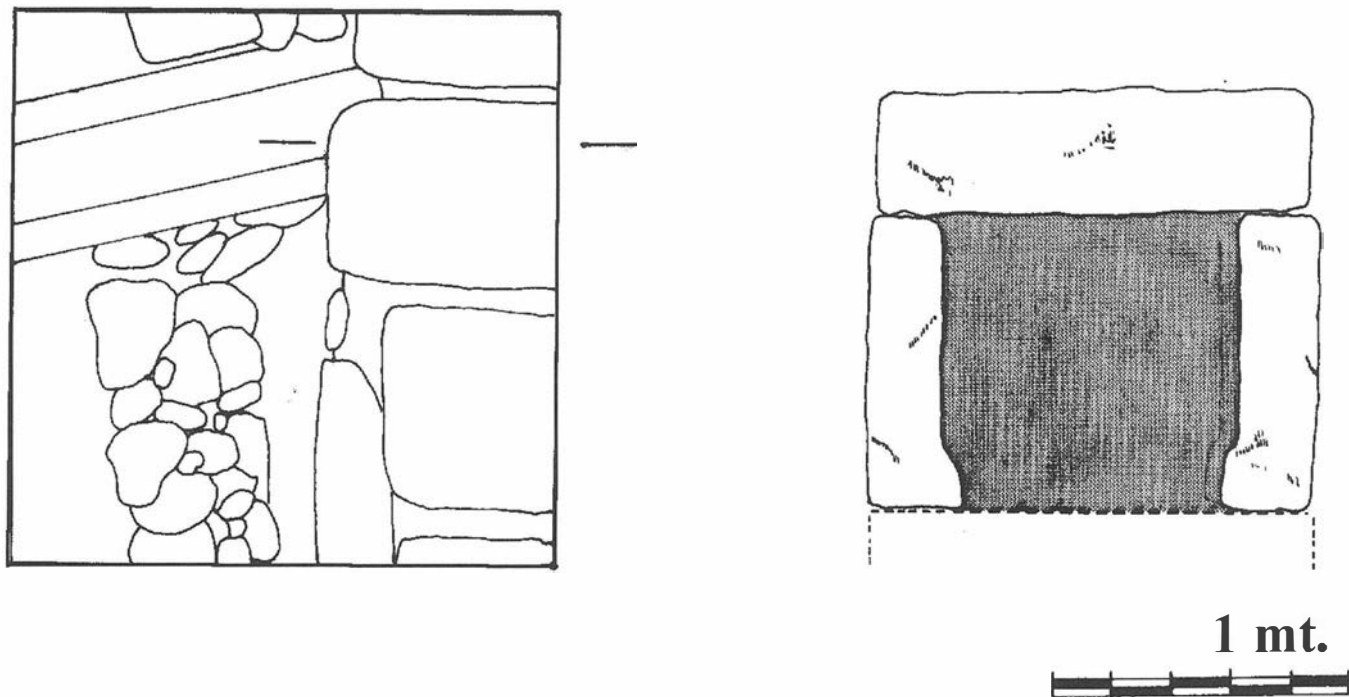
Planta y sección cloaca UE-123, altoimperial.
